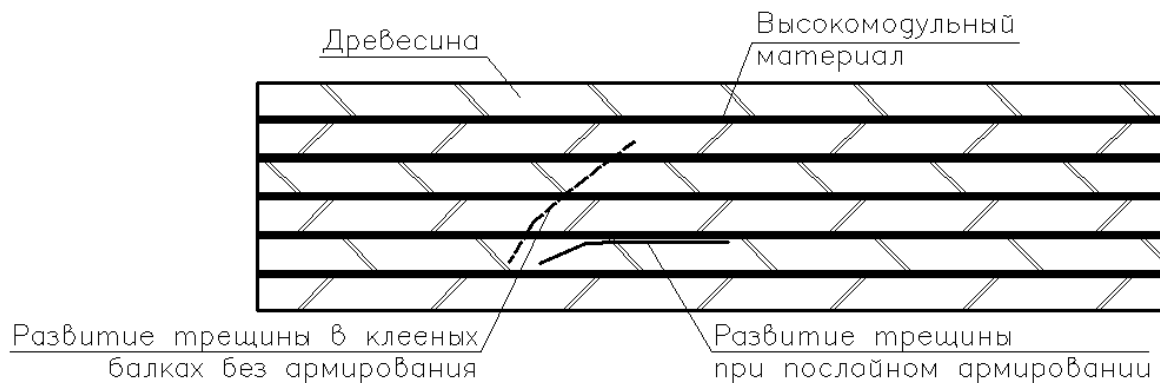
Развитие трещин клеодощатой и армированной балки по длине конструкции
